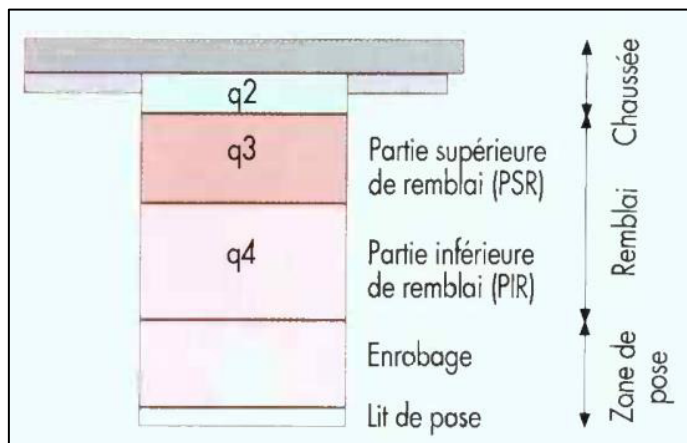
Cas d'une tranchée sous chaussée, Guide de remblayage des tranchées et réfection des chaussées
